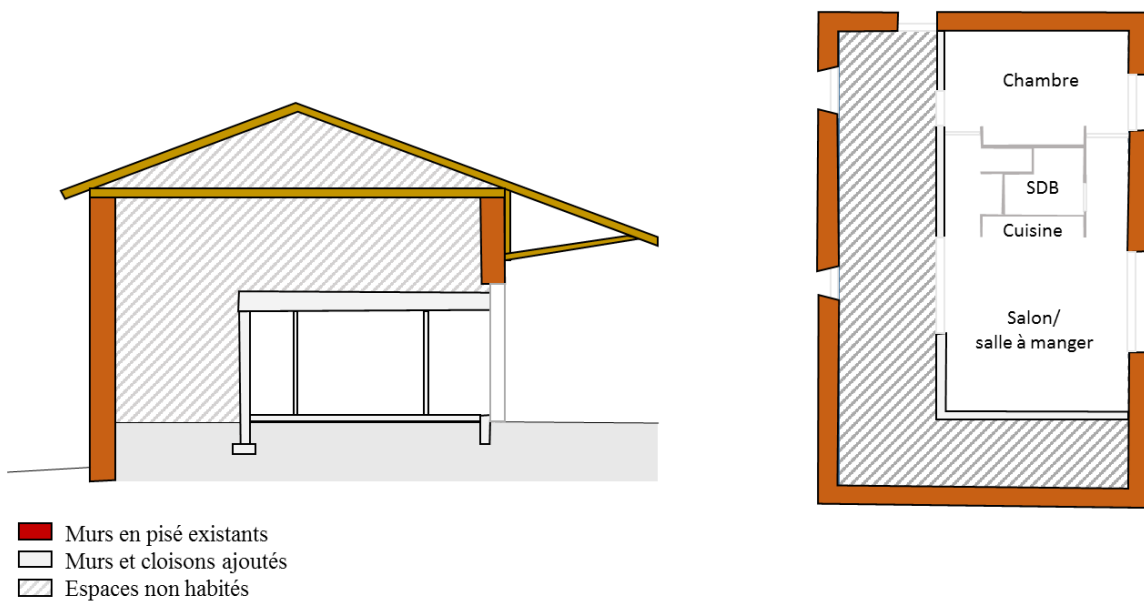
Coupe et plan schématique du projet de Pressins, redessinés à partir des plans réalisés par Christian Ochoa.
